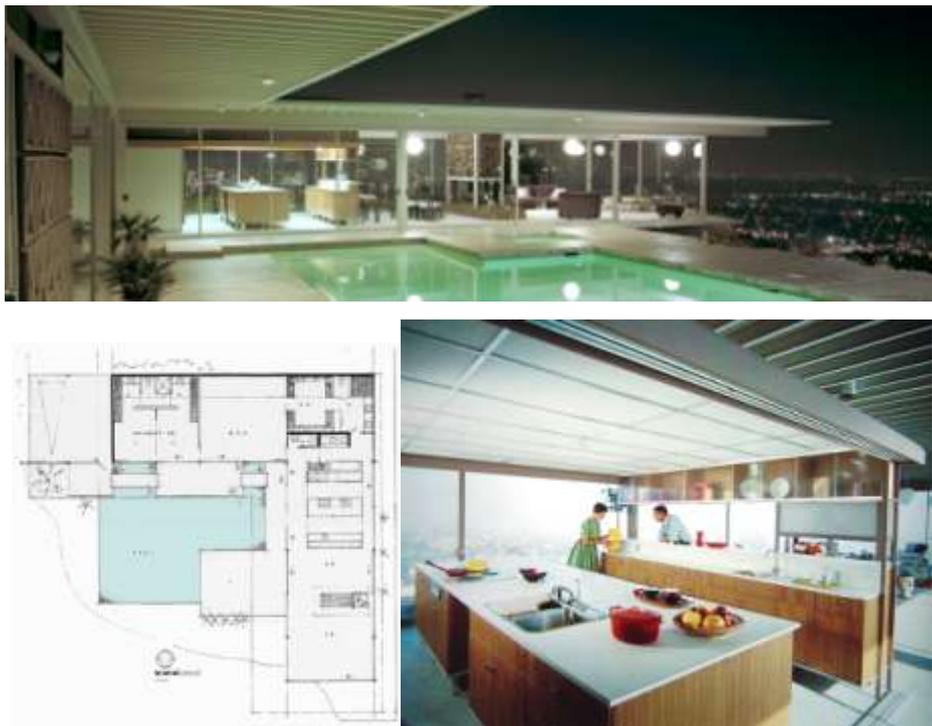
Case Study House #22: a) Vista da sala; b) Planta; c) Bloco cozinha (NEIL, 2007).
